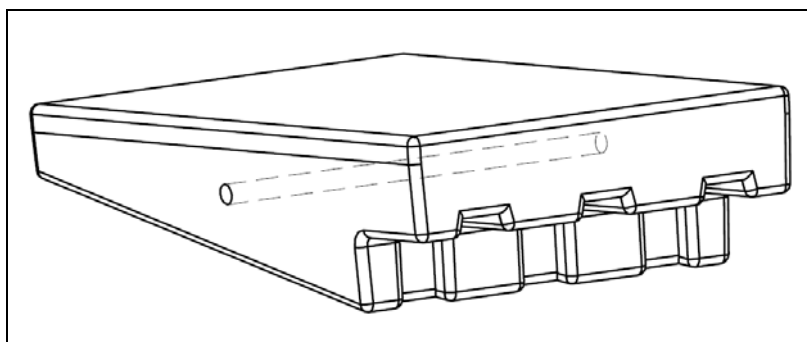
Vista 3D del bloque del aliviadero de Barriga. (Fuente: Armortec, Inc.)
